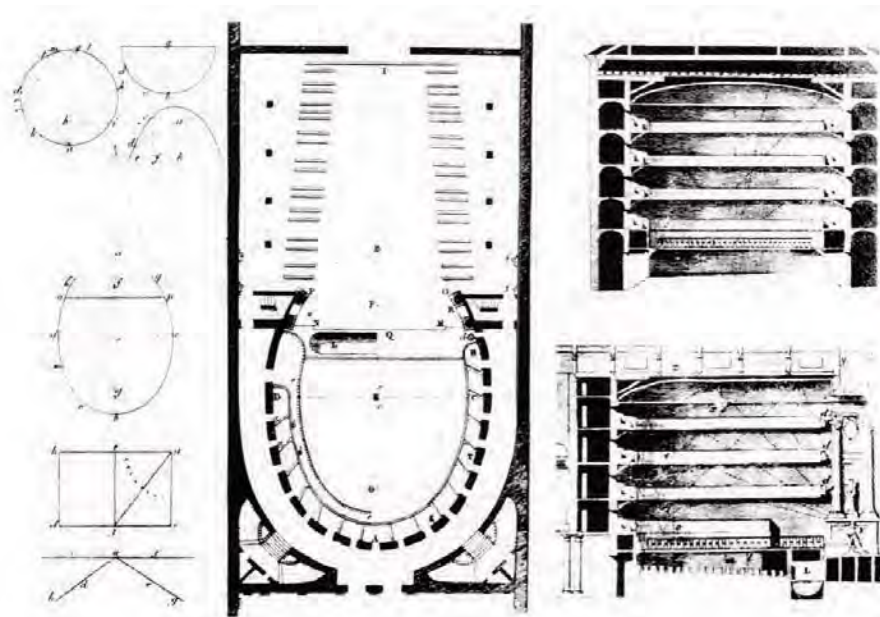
Pianta proposta dal Landriani. ©Google.
